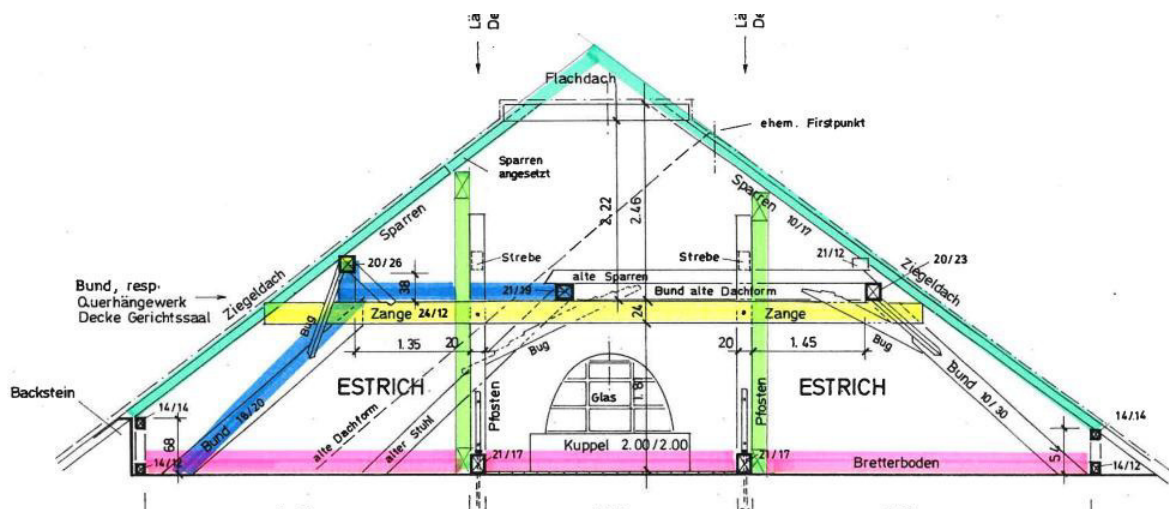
Querschnitt Dachraum mit der Lage der neuen Bauteile
